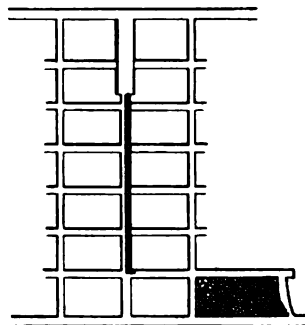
Auffahren einer Grundstrecke mit breitem Blick.
